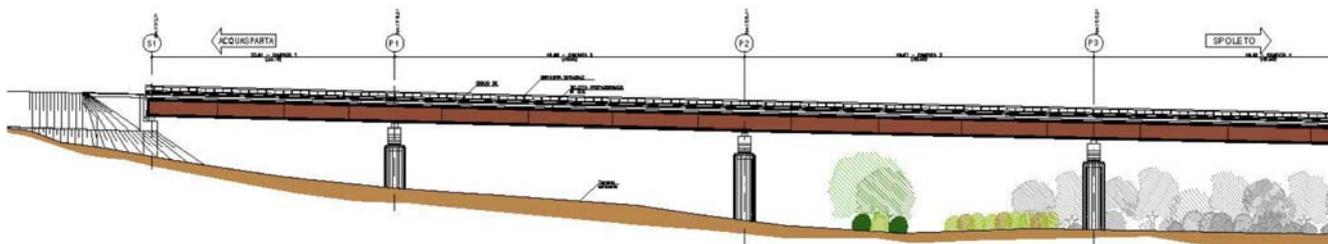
Prospetto del viadotto. Pile 1-2-3 con indicate le mitigazioni
